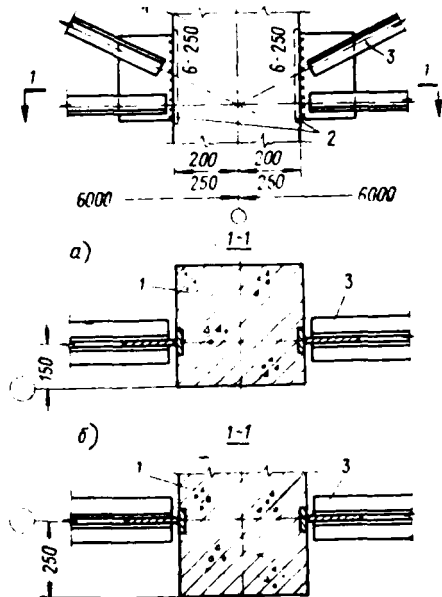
Деталь крепления вертикальных связей к колонне продольного факверка стен
